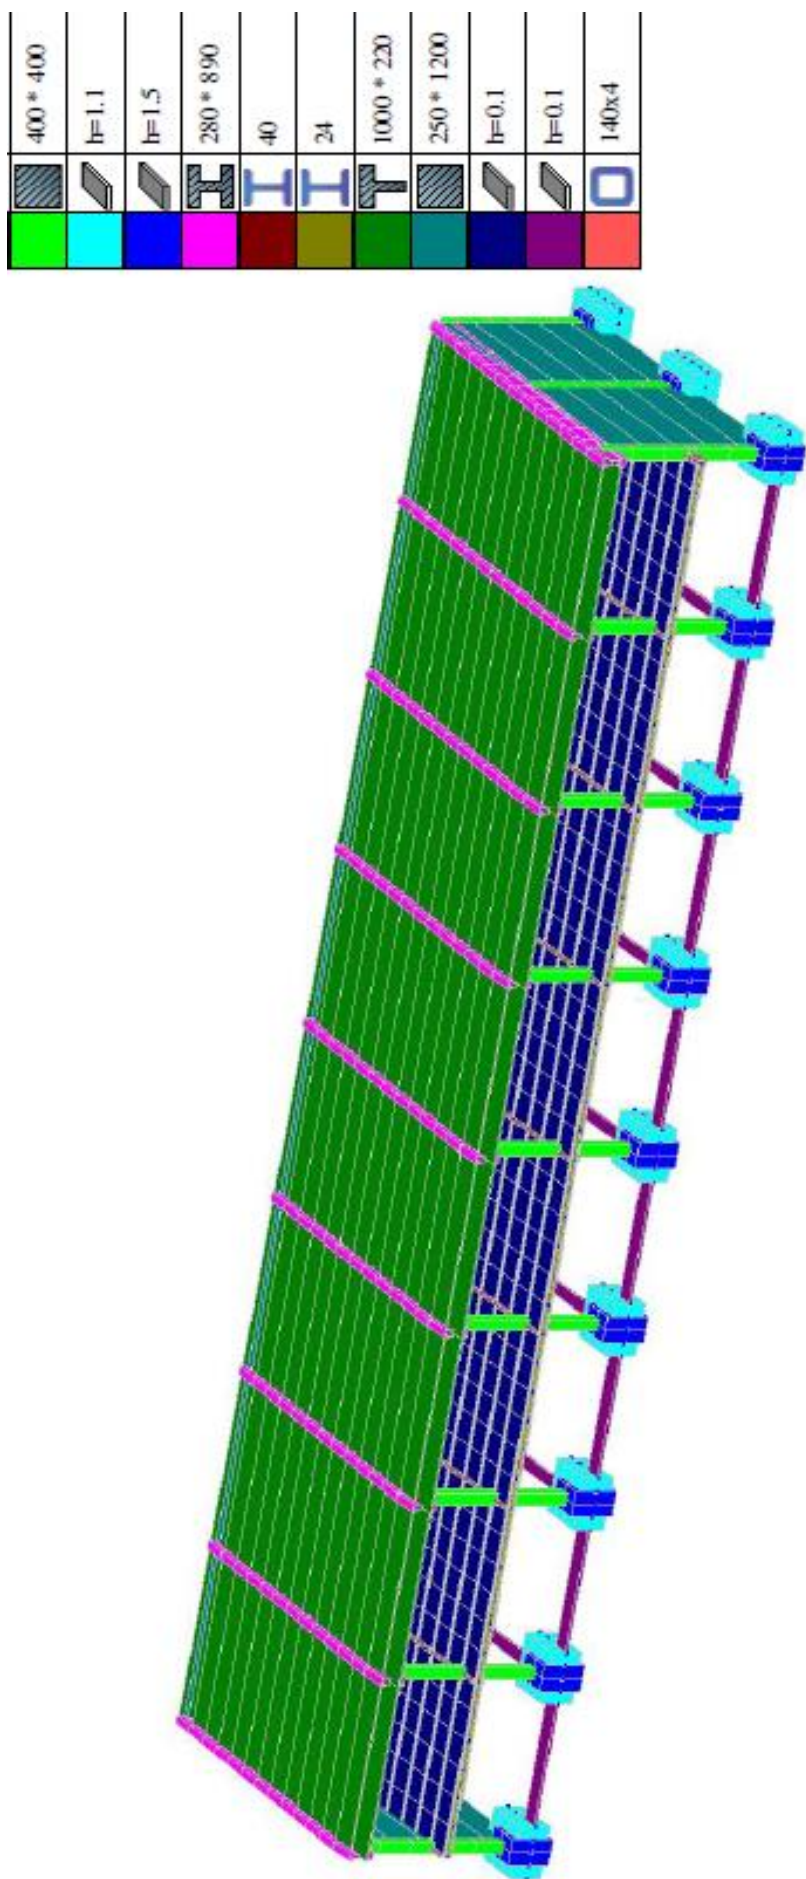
Розрахункова схема будівлі у вісях 1-3 рядах А1-К1.
